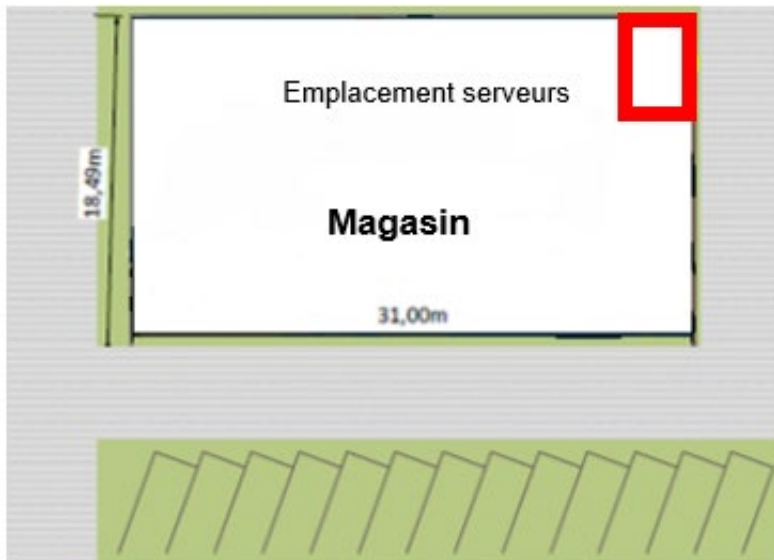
Plan d'implantation du de la baie serveur à Brest
